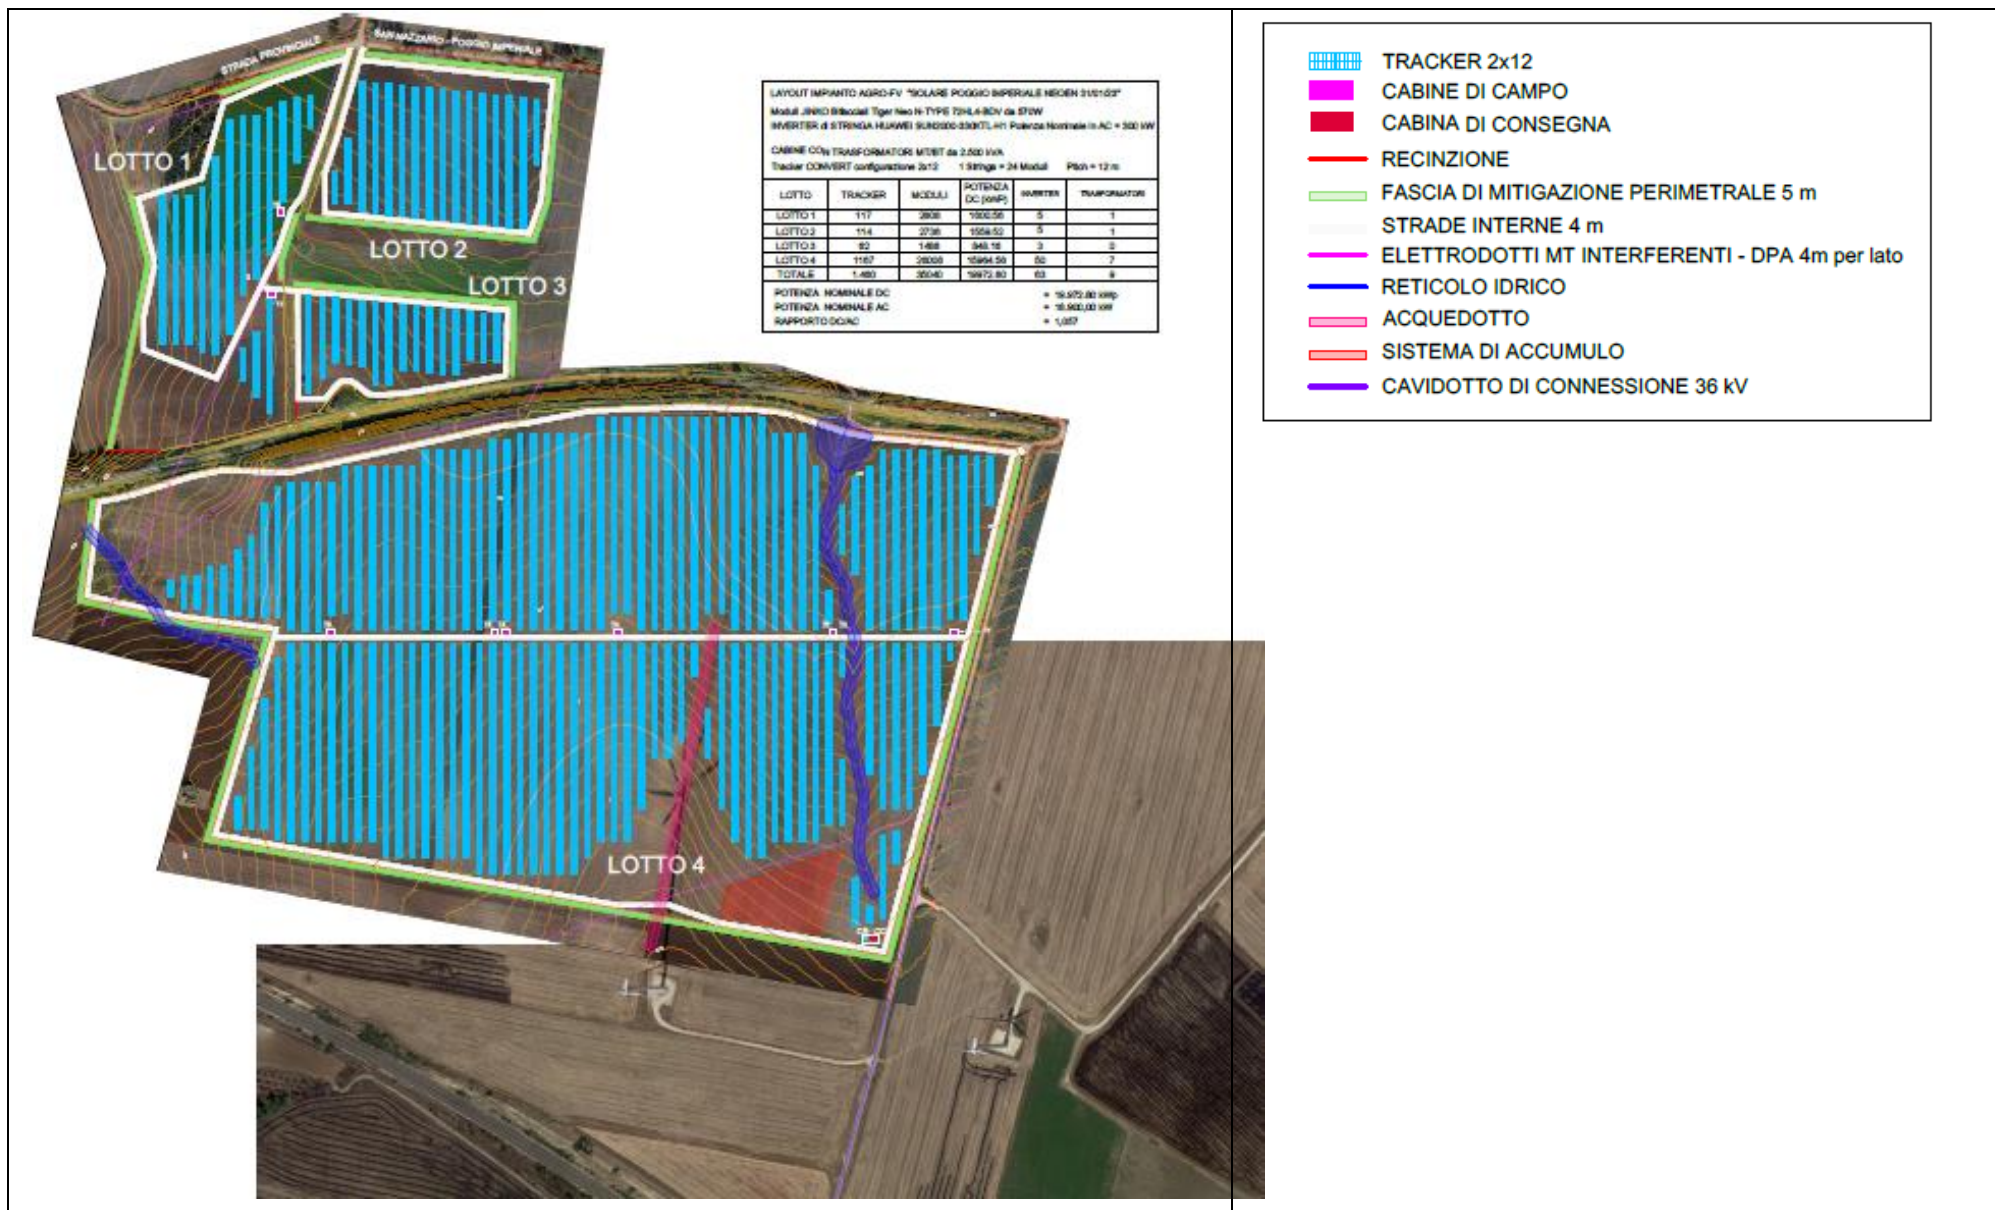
Layout di progetto con indicazione di tutti gli elementi.
